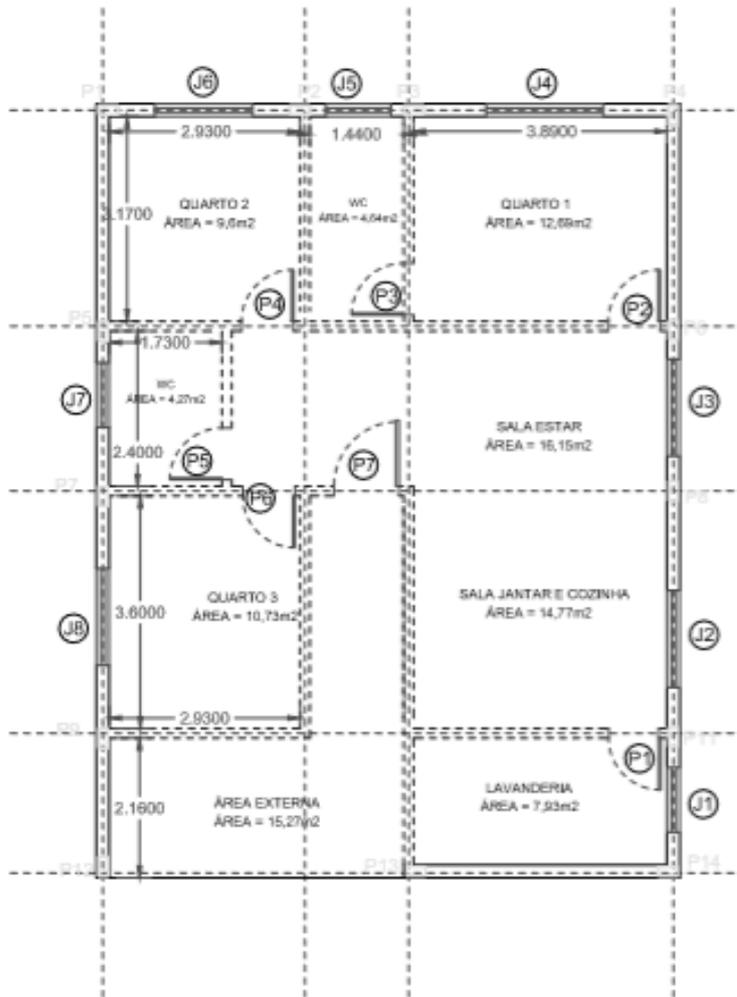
Planta Baixa (Método construtivo convencional)
